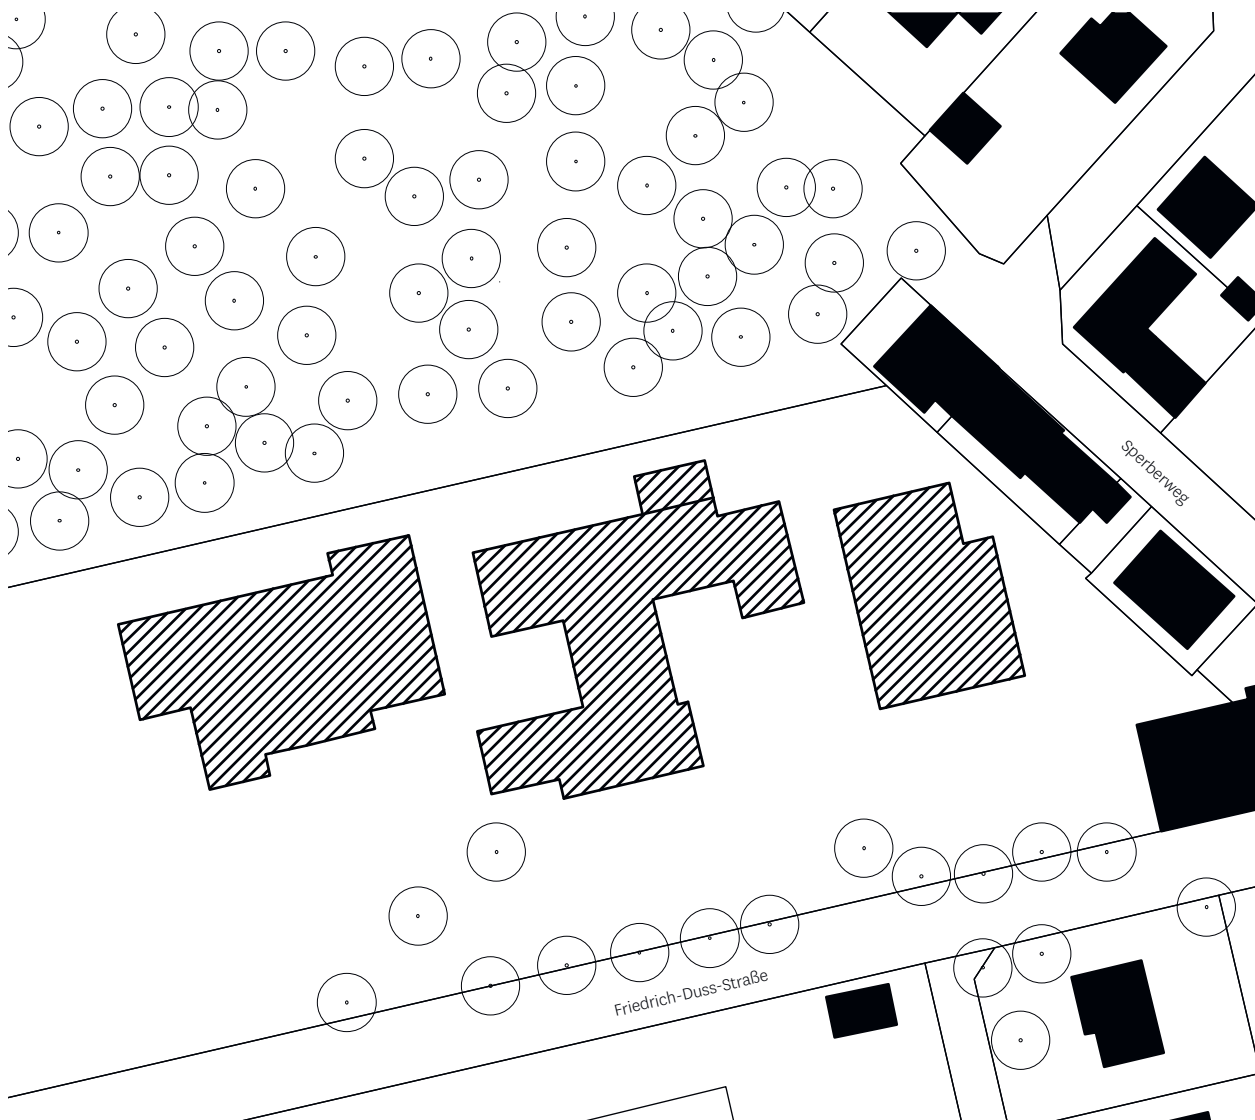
Lageplan genordet - Maßstab 1:1.000
